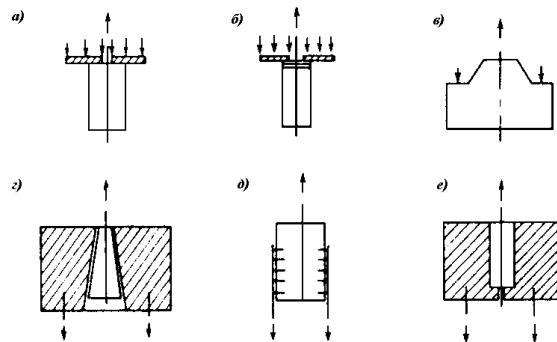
Відомі схеми випробувань зчеплення арматури та пінобетону.
